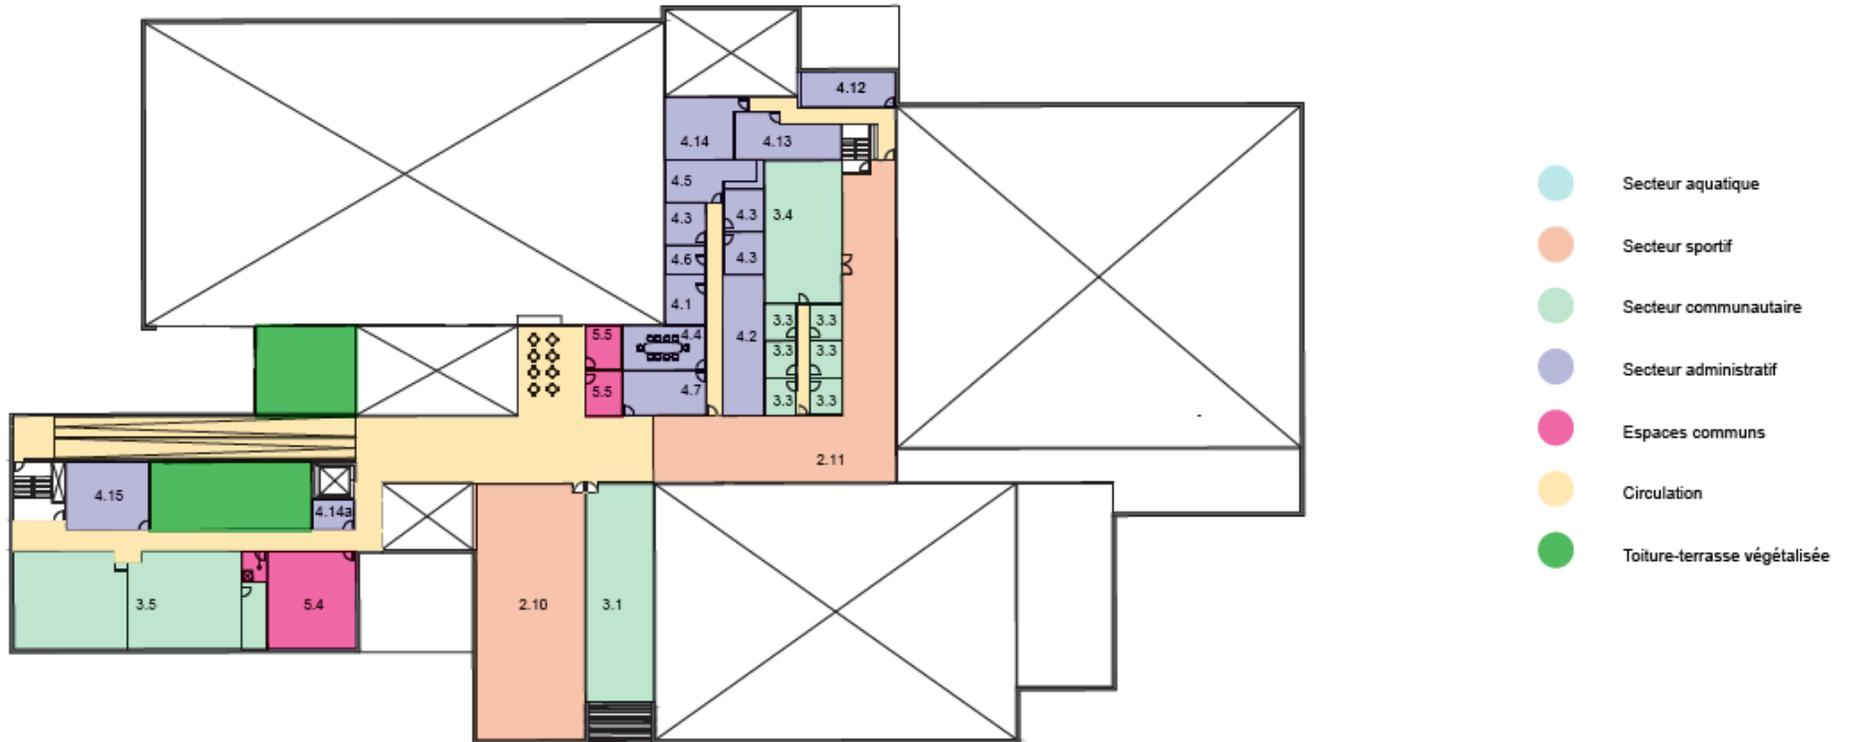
Plan du sous-sol | Complexe multifonctionnel
